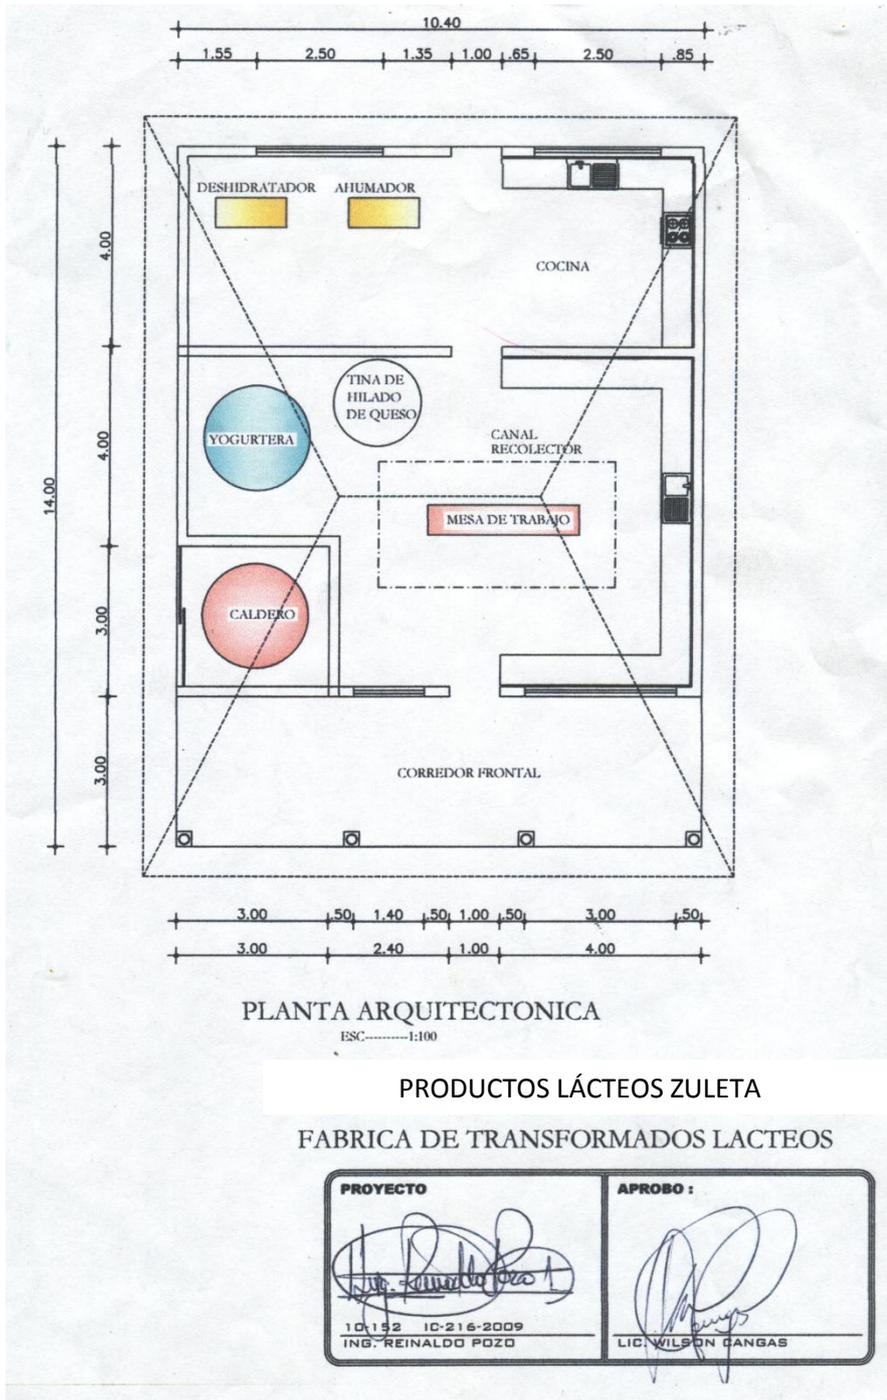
Plano de Distribución Planta Procesadora
